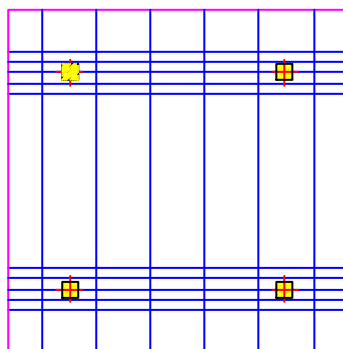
Lajes Unidirecionais com “Steel Deck” + Vigas
